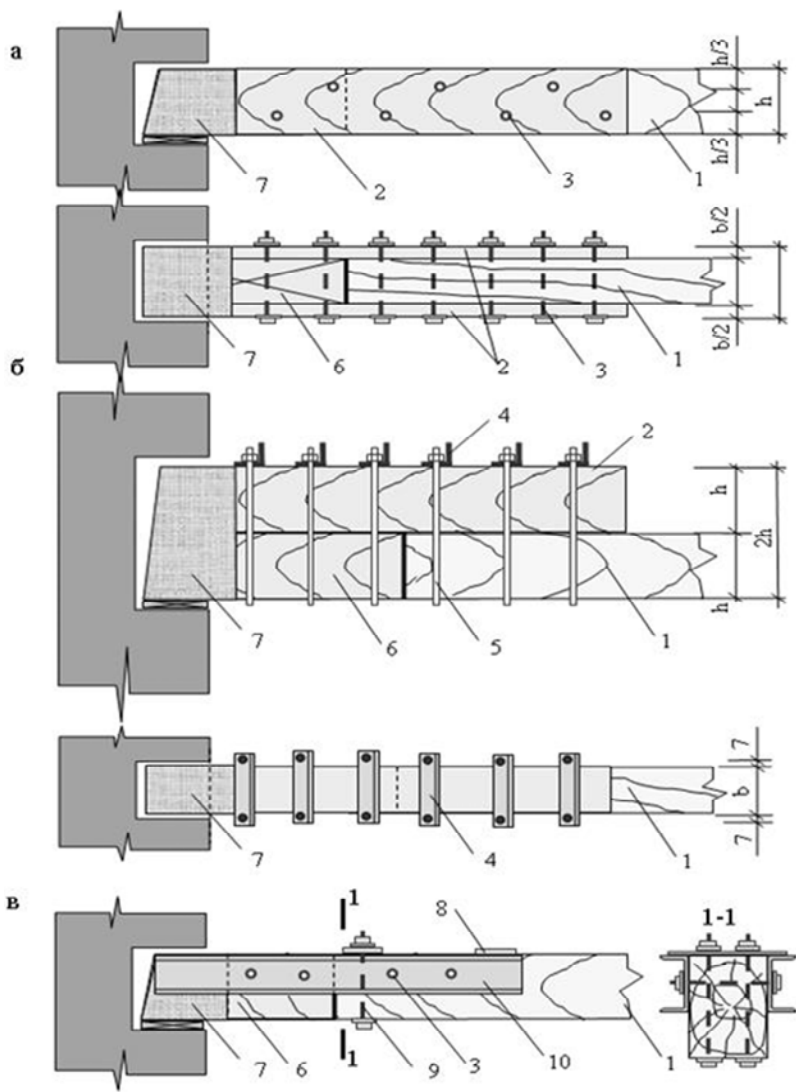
Усиление опорных участков деревянных балок накладками:
